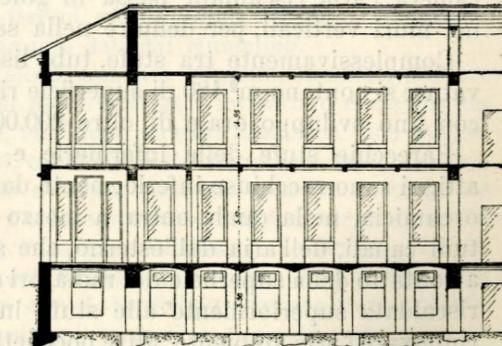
Sezione longitudinale di metà padiglione (Scala 1:360).
